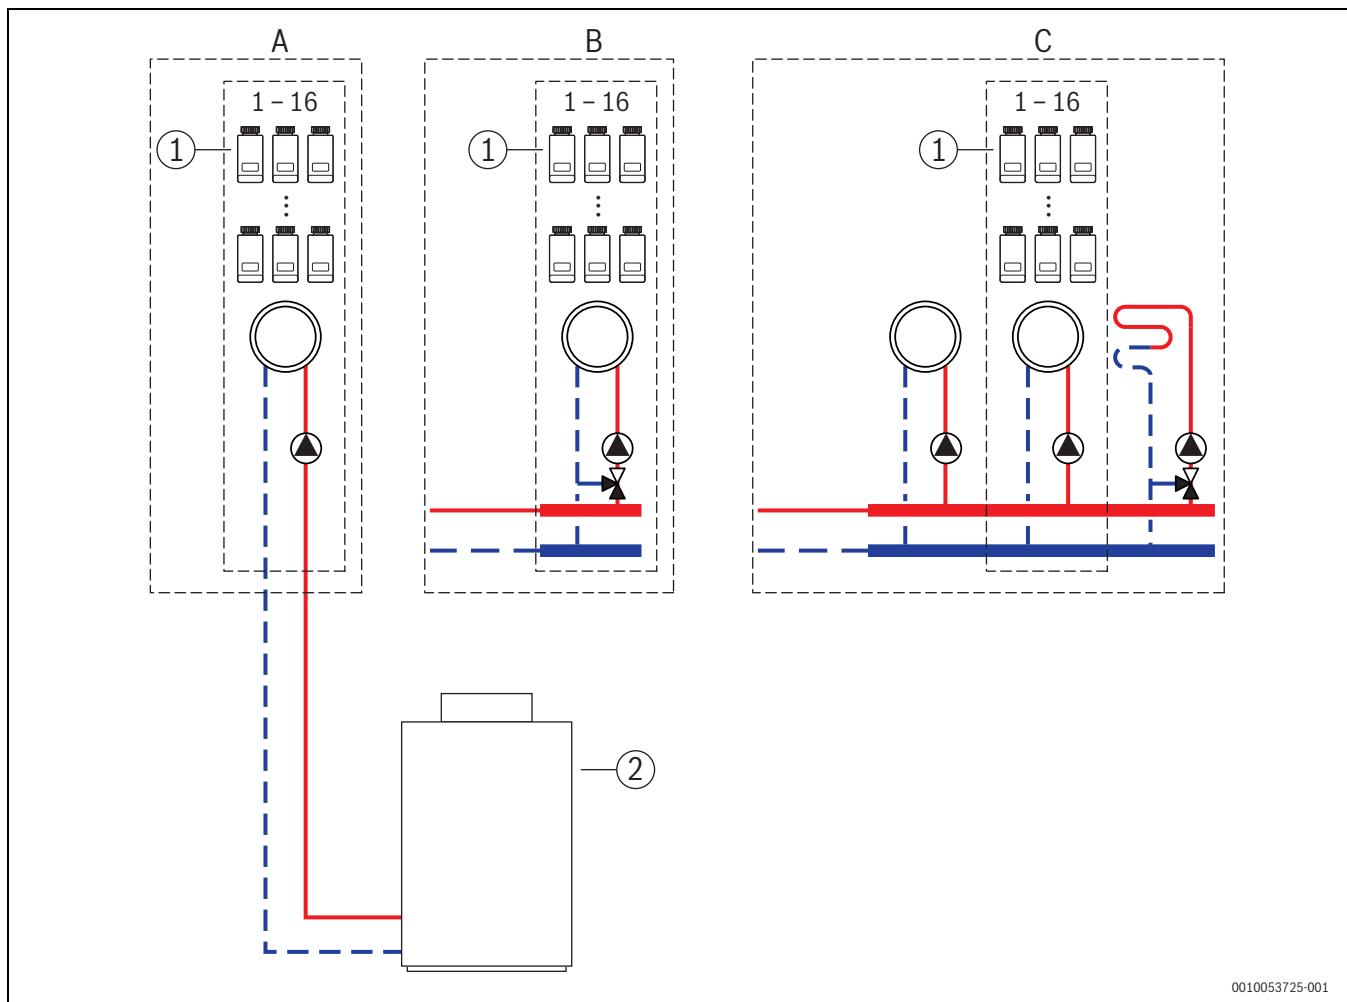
Schema dell'impianto (schema di principio non vincolante)
